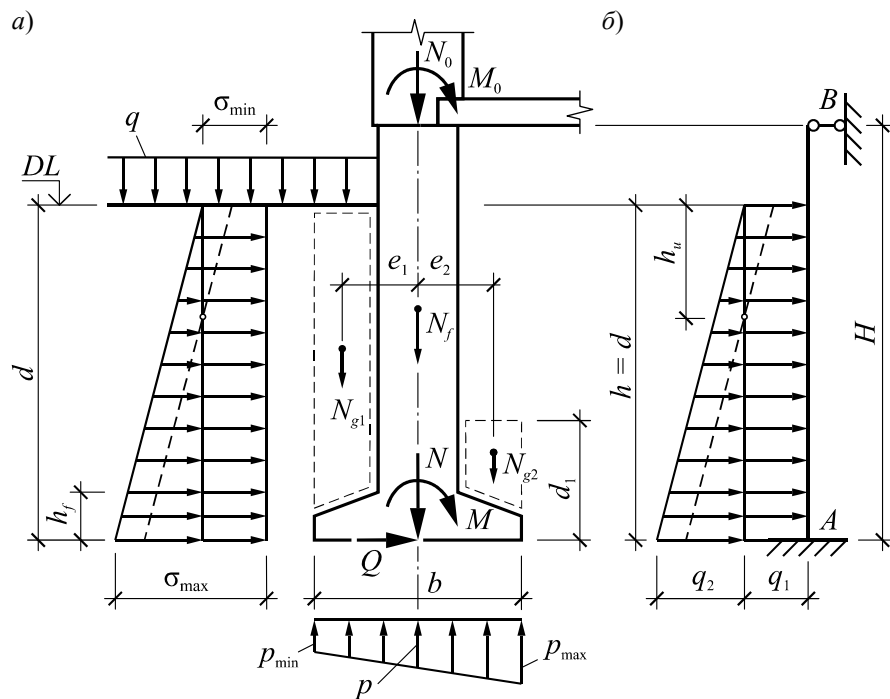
Расчетные схемы к сбору нагрузок на основание ленточного фундамента для здания с подвалом
